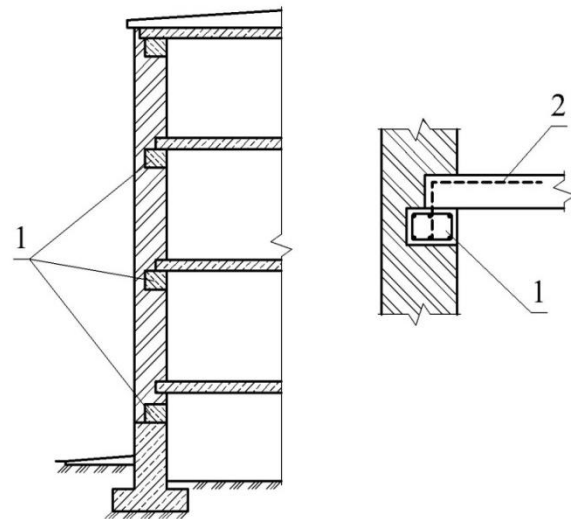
Схема устройства железобетонных поясов жесткости:
